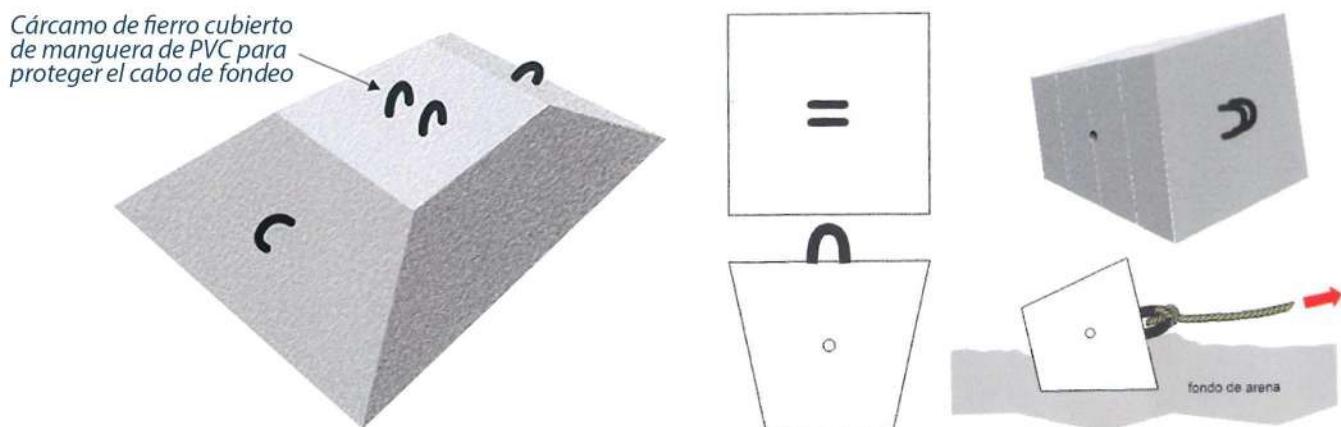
fondeo de concreto diseñado para la instalación de Long line en Caleta Buena.
